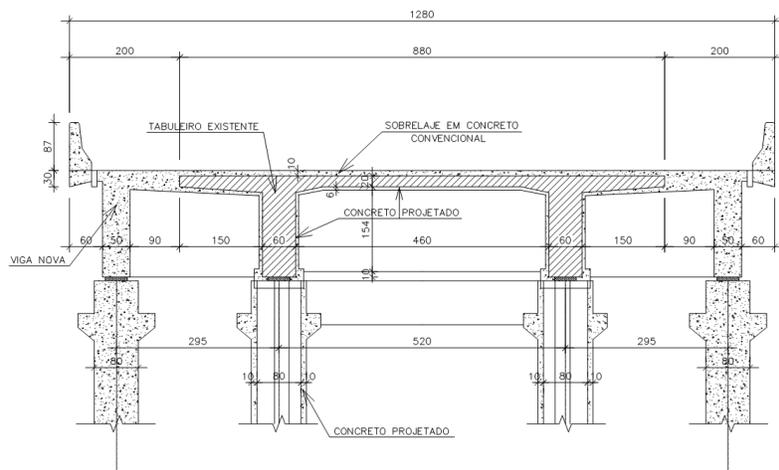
Seção transversal após alargamento e reforço da ponte com concreto armado convencional.
